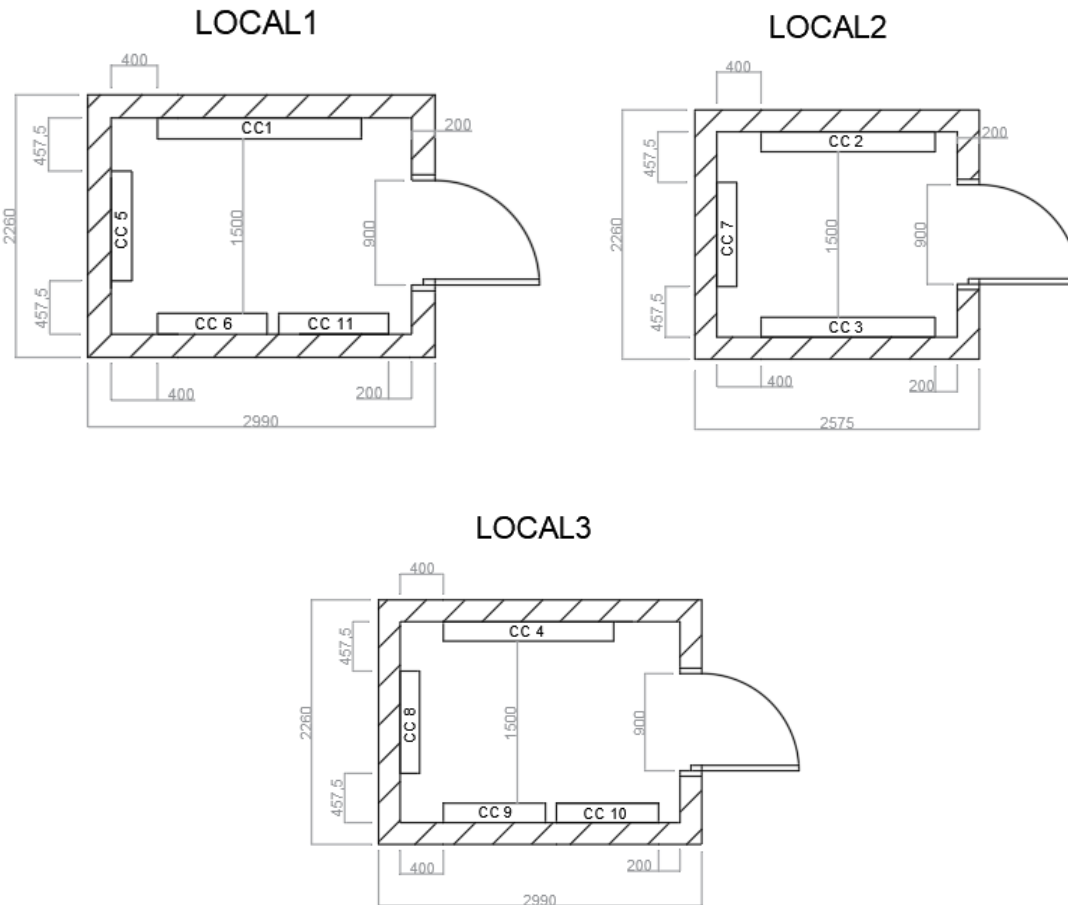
Dimensiones de los locales de centralización de contadores. Fuente. Elaboración propia.
